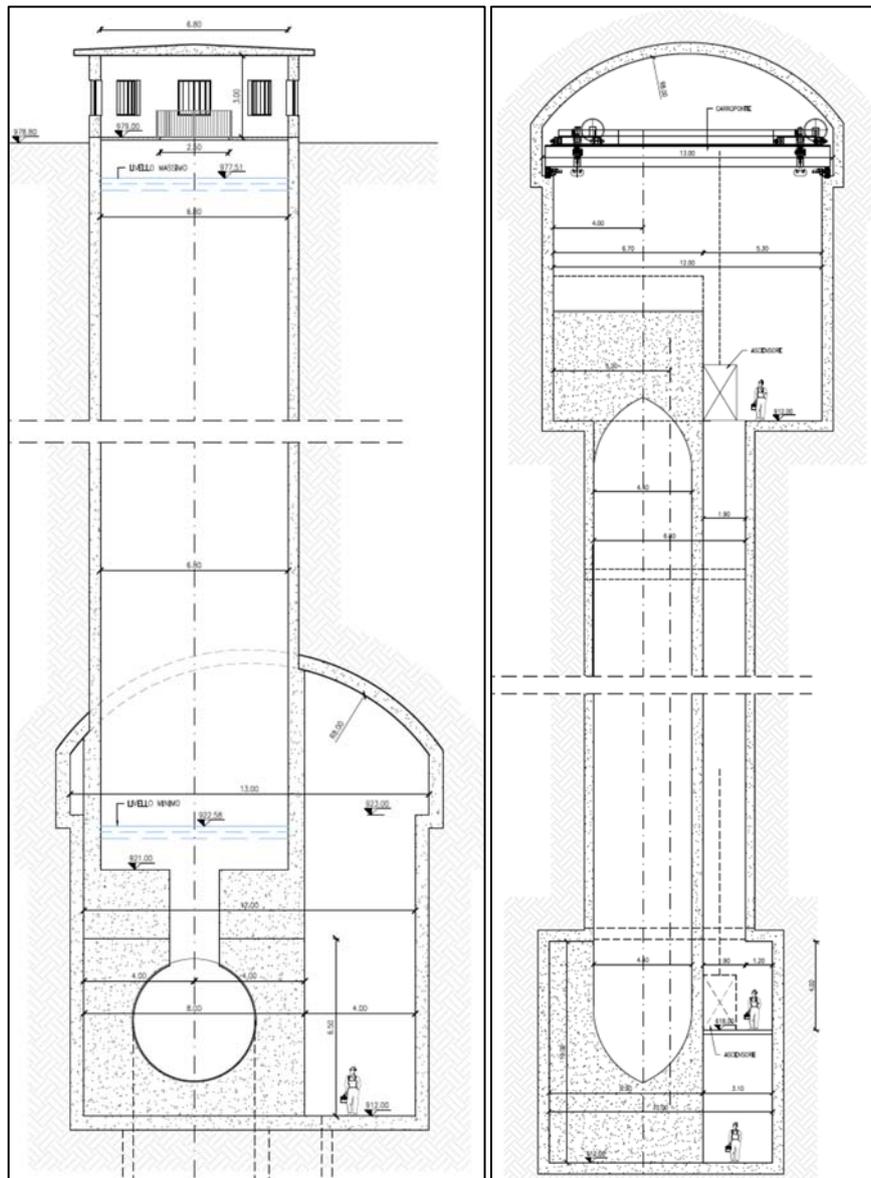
Sezione della caverna alla base del pozzo piezometrico in corrispondenza del pozzo piezometrico (sx) e del tratto verticale della condotta forzata
